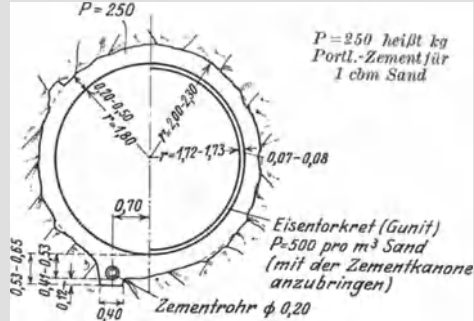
Druckstollenquerschnitt im festen Gestein ohne und mit zugfester Dichtungseinlage aus eisenerbettem Torkret. Maßstab 1 : 150.
